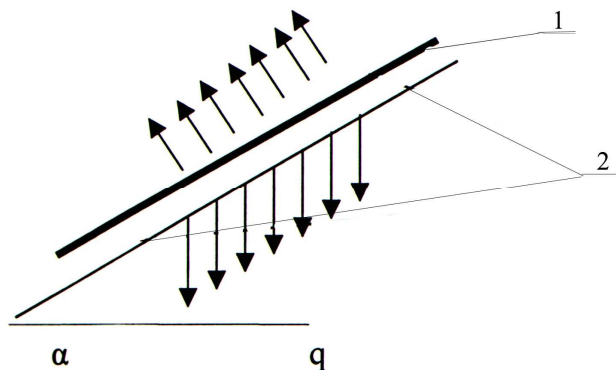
Схема дії навантажень на рулонний килим:
